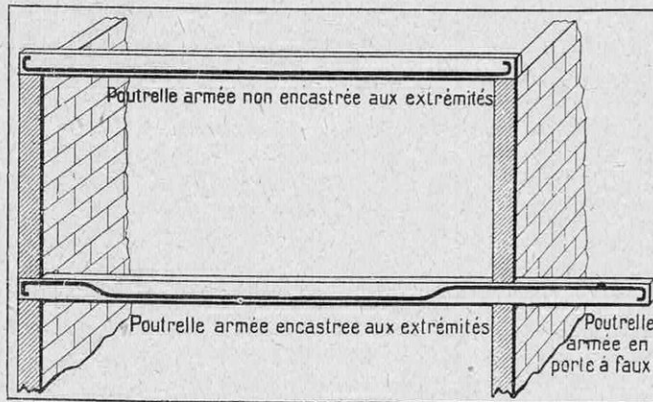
LE BÉTON NE DOIT PAS ÊTRE ARMÉ DE LA MÊME FAÇON SUIVANT LA POSITION DE LA POUTRE
